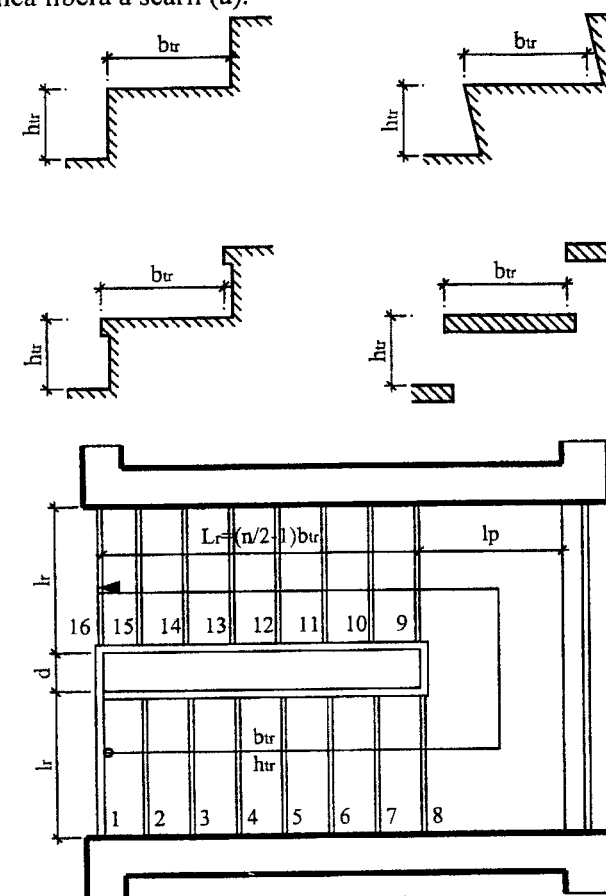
Dimensiuni funcționale ale unei scări cu două rampe paralele
